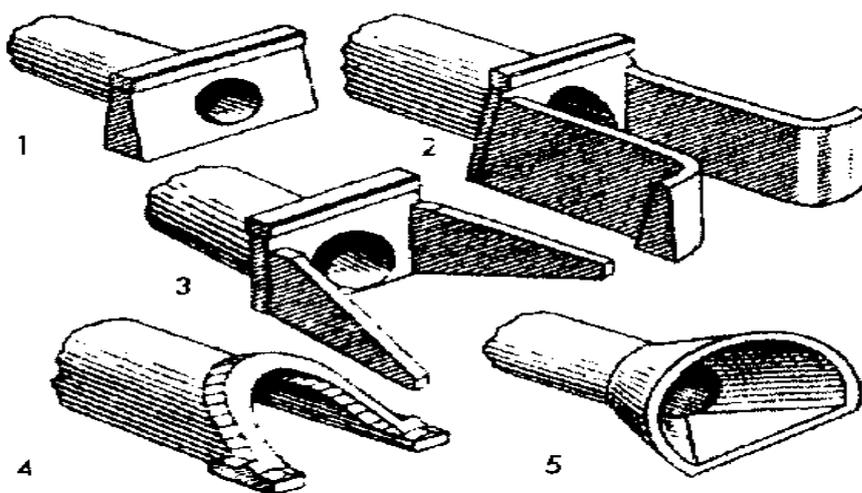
Типы оголовков: 1- порталный; 2- коридорный; 3- раструбный; 4- воротниковый; 5- обтекаемый.
